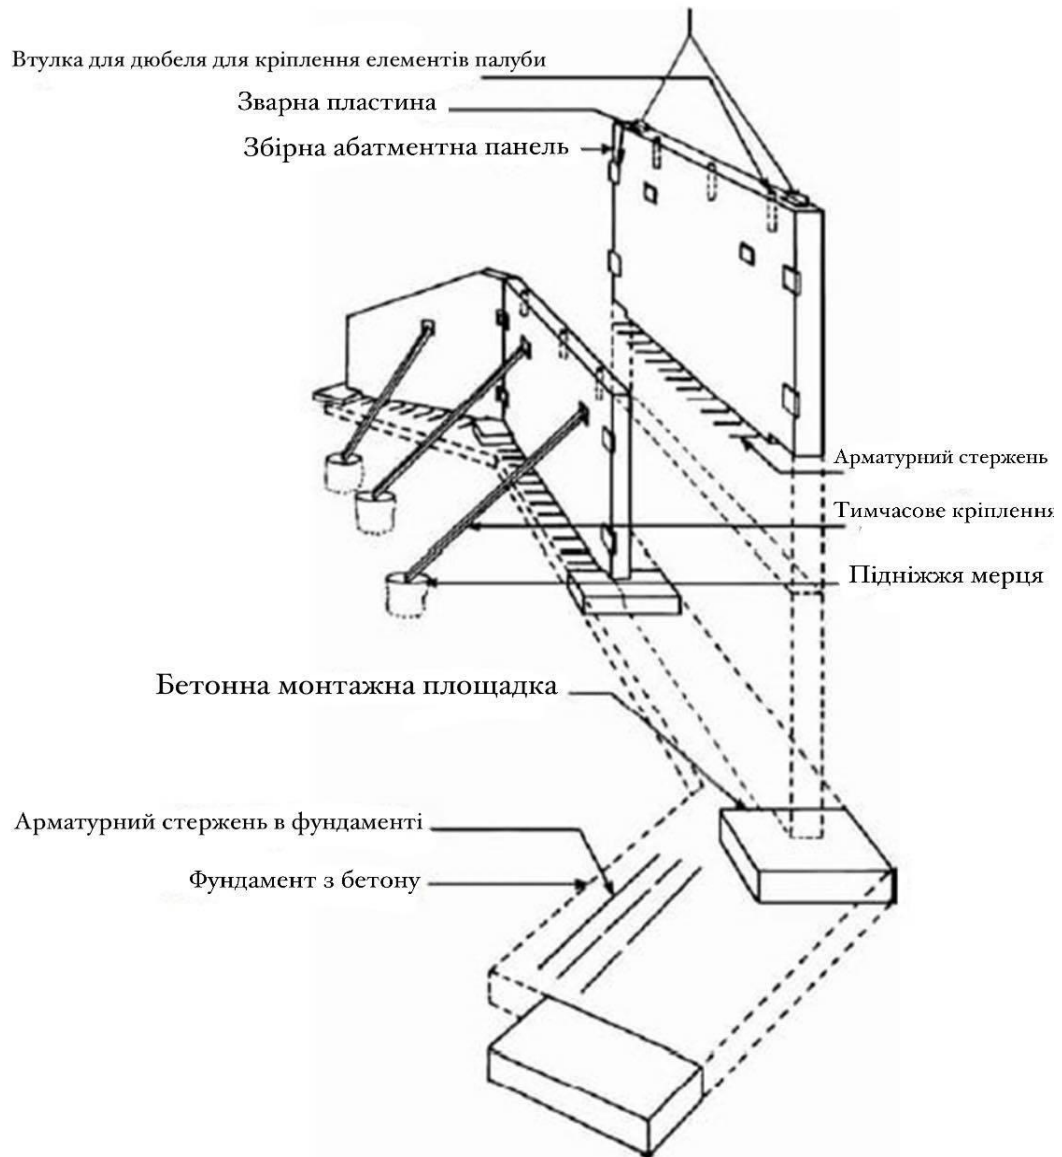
Збірна бетонна ферма та стіна павільйону
